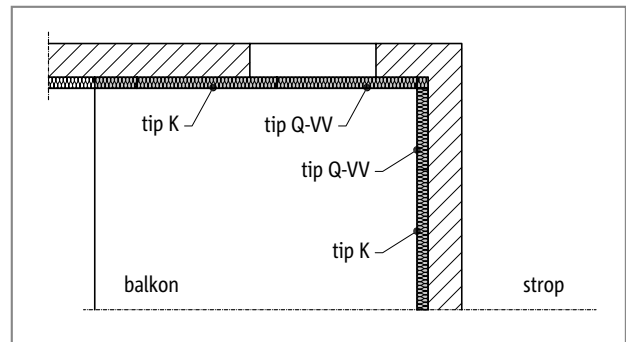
Schöck Isokorb® tip K: nepodprt konzolni balkon
